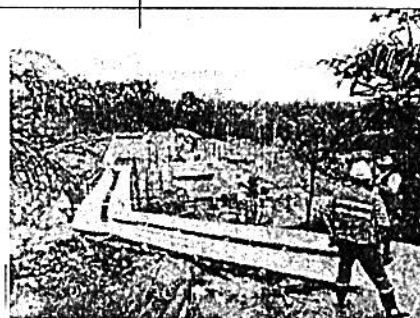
Construcción planta de tratamiento de aguas residuales - PTA
